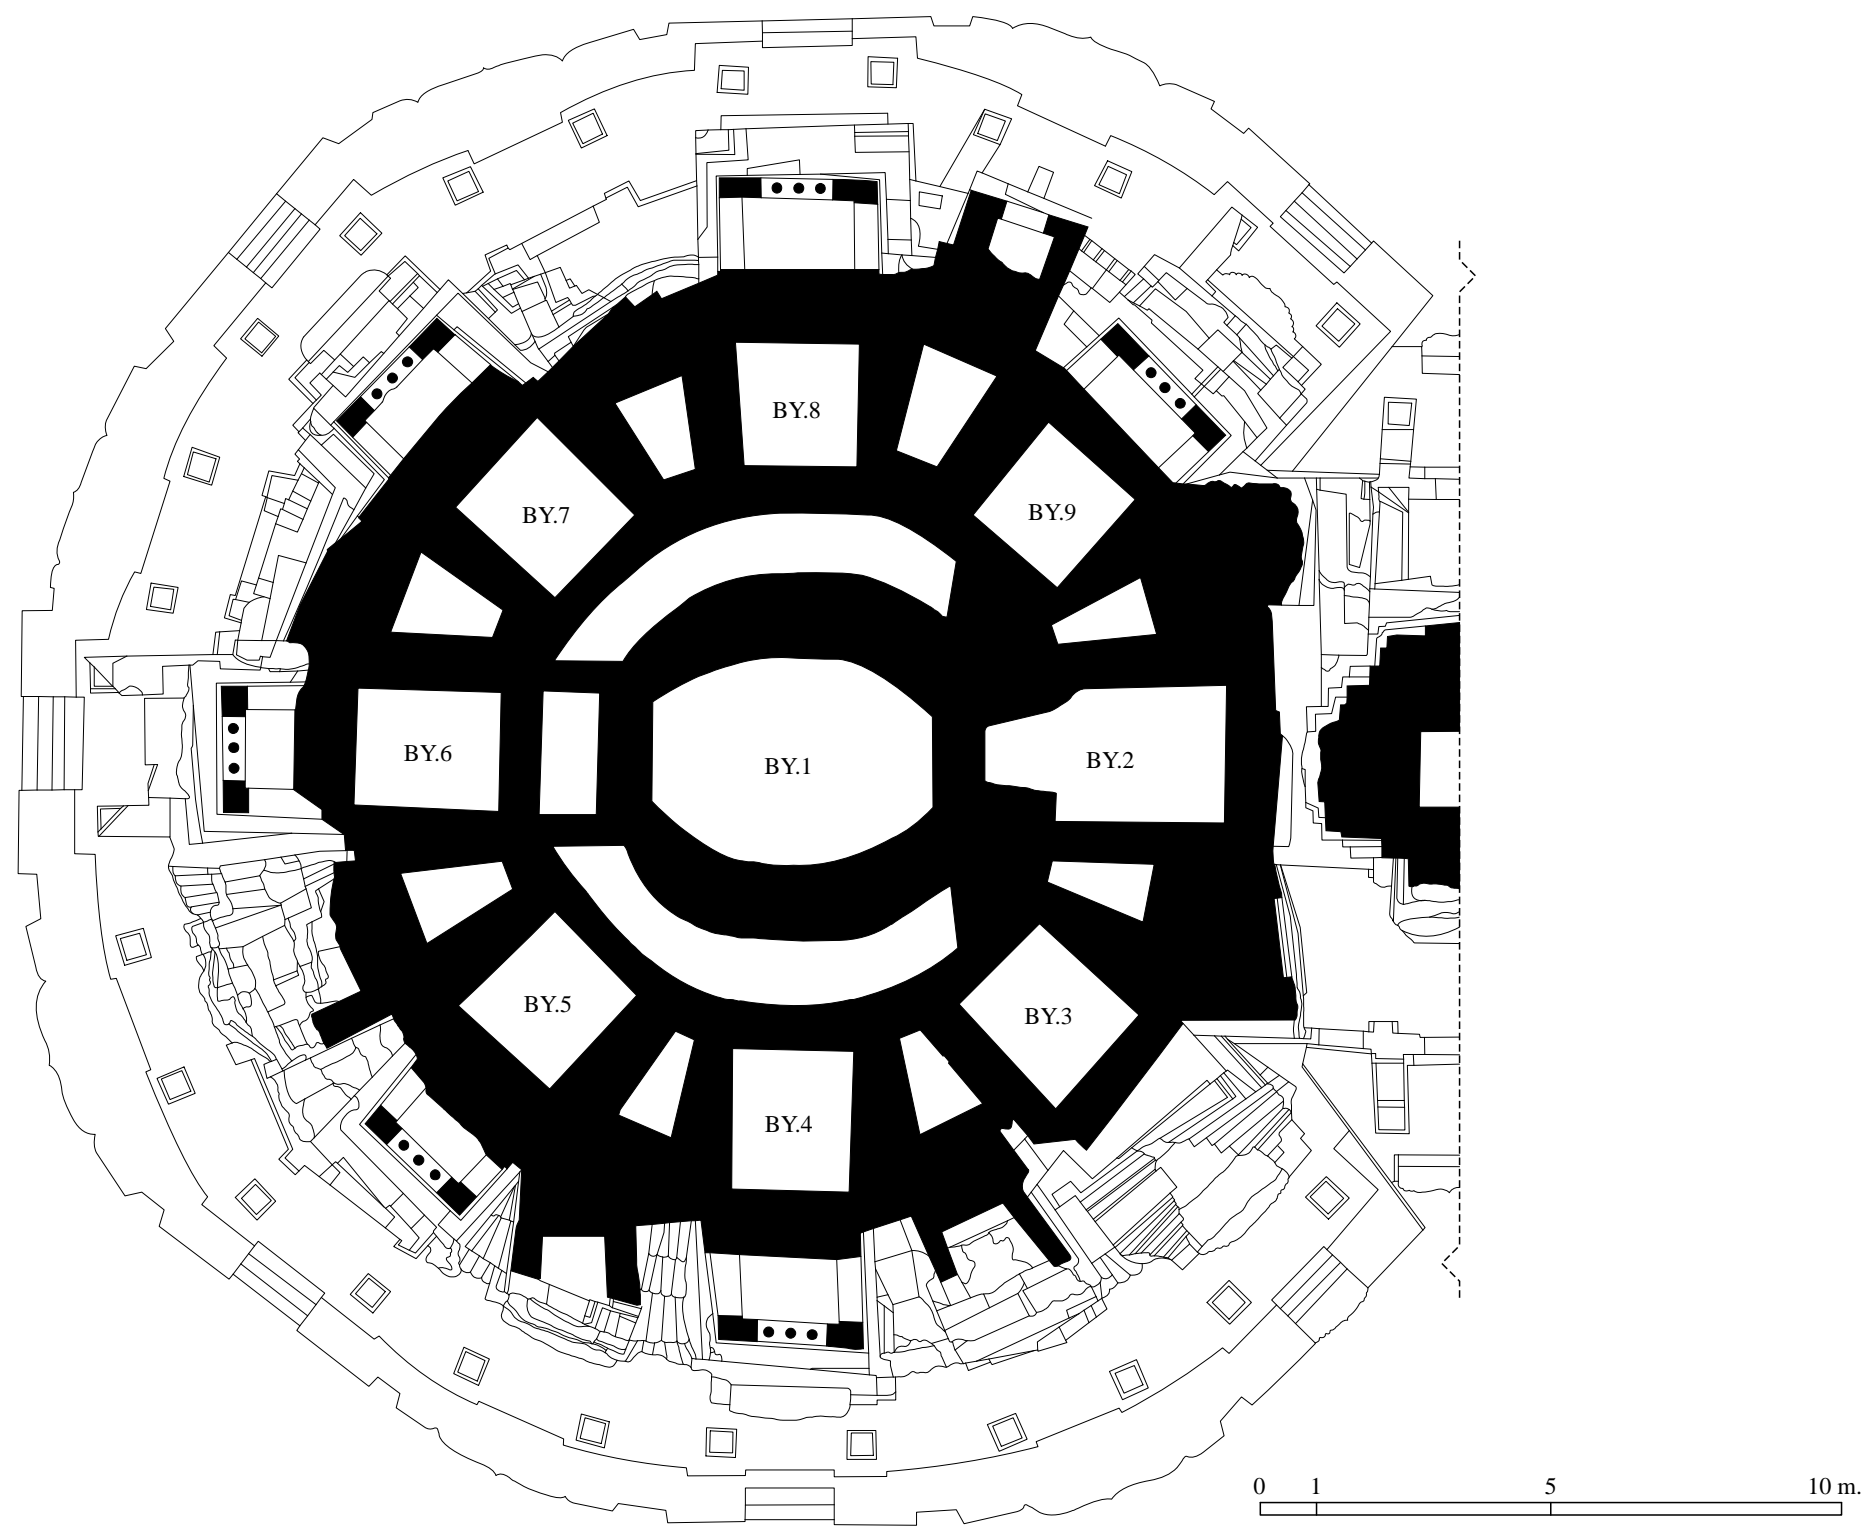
Plan du massif central horizontal à hauteur des faux-porches des tours adjacentes
